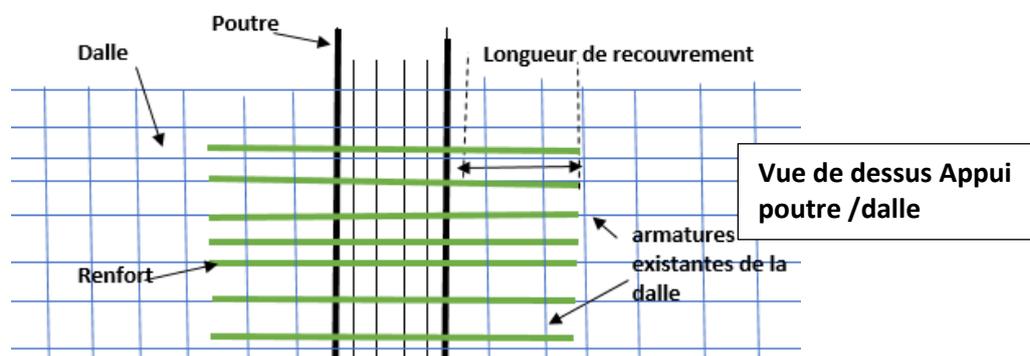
Principe d'implantation des barres au droit des appuis poutre/dalle
